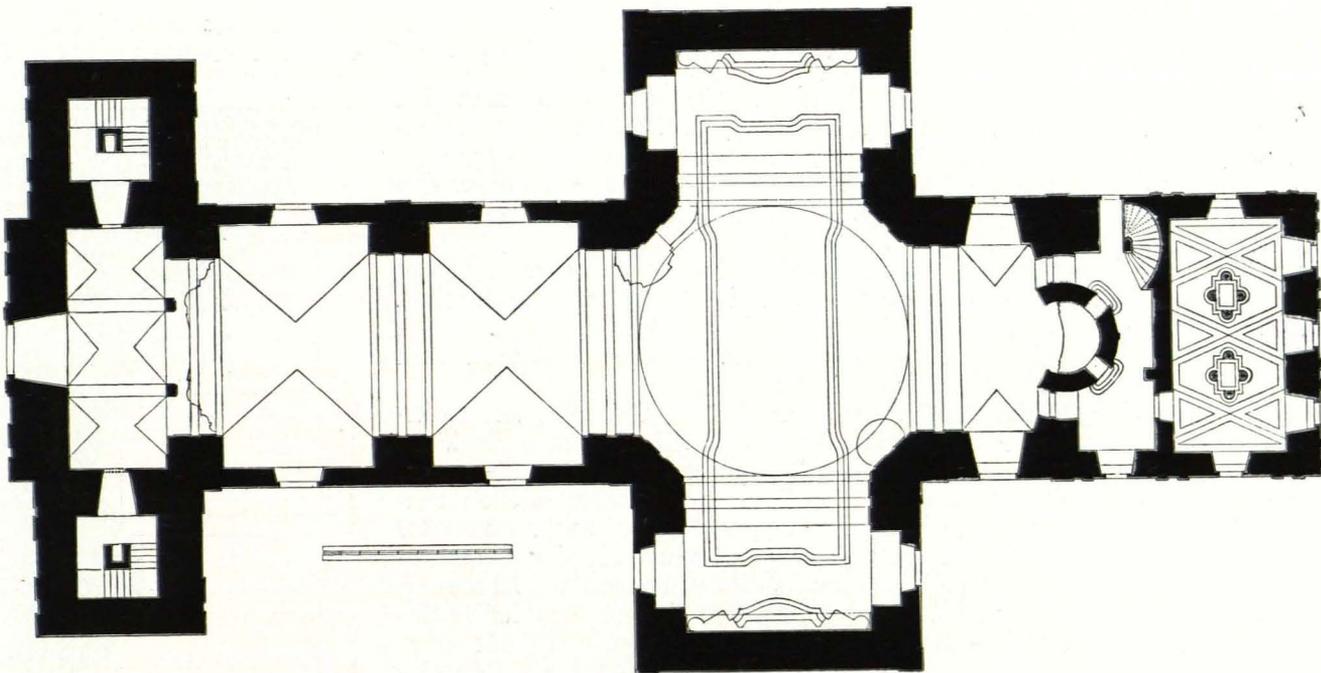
Maria-Taferl, Wallfahrtskirche, Grundriß 1 : 400 (S. 98)
